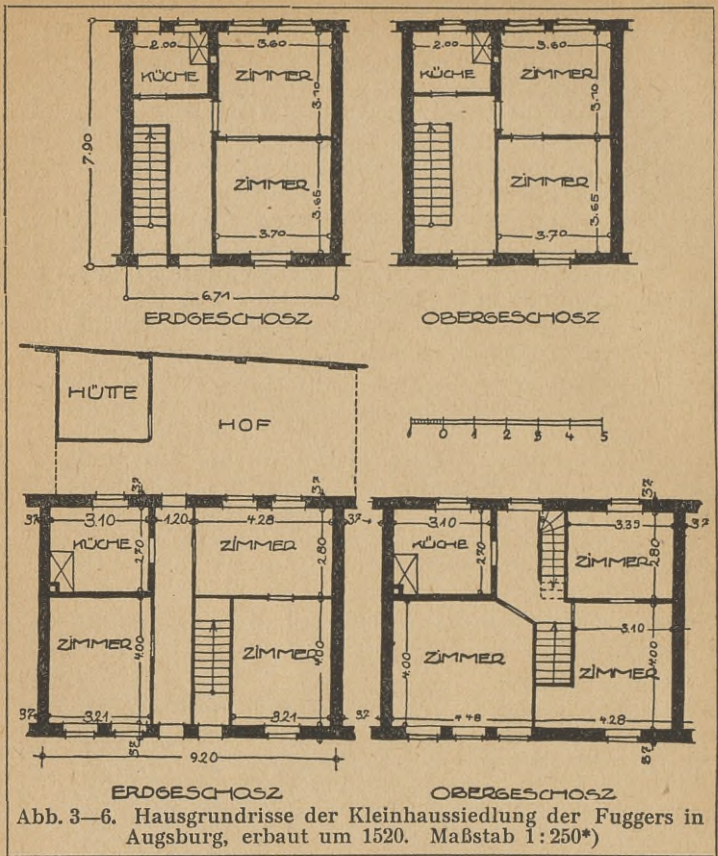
6. Hausgrundrisse der Kleinhaussiedlung der Fuggers in Augsburg, erbaut um 1520. Maßstab 1:250*)
